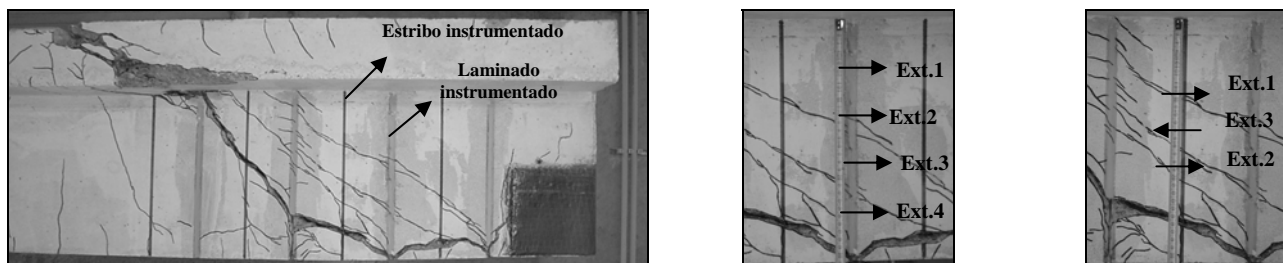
Localização dos extensômetros no laminado e estribo instrumentados da viga 4S-4LVa-B.
